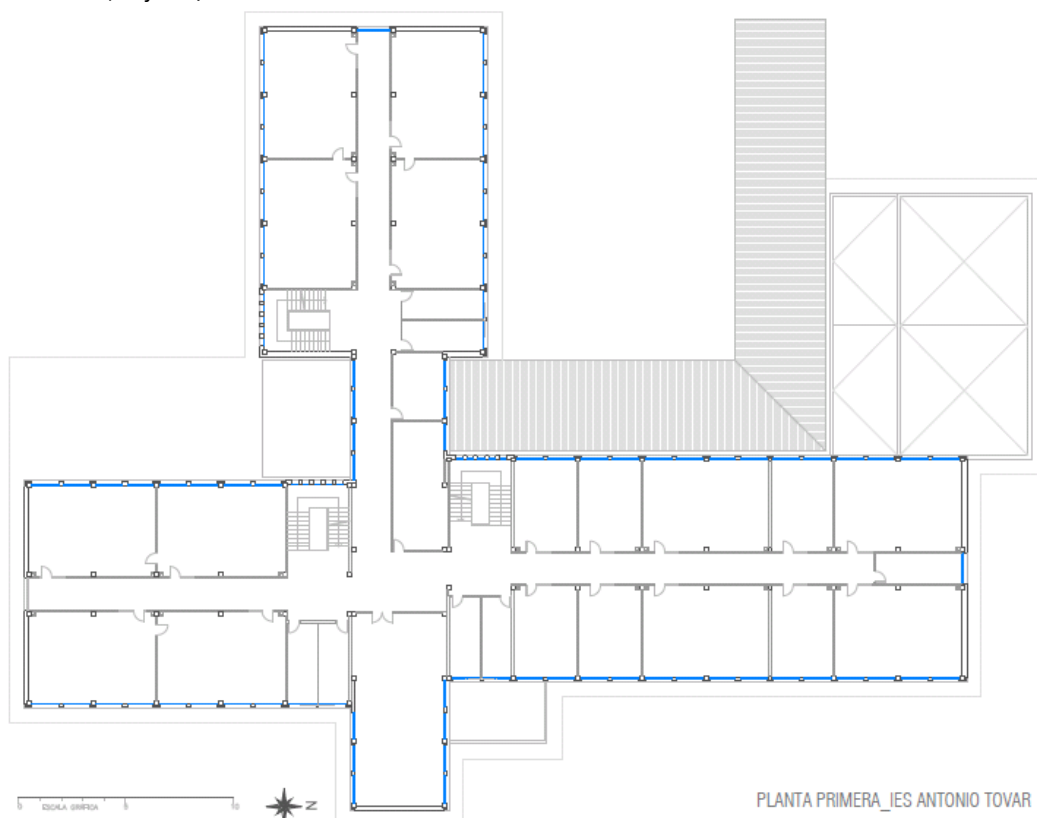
Planta primera del IES Antonio Tovar. Archivo Histórico Provincial de Valladolid, Sección Educación, caja 81/25.
